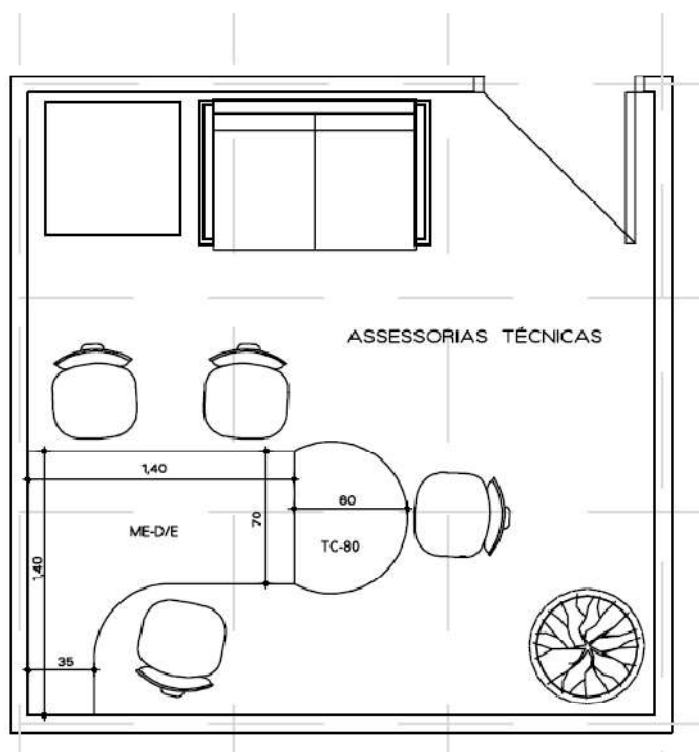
Planta baixa sala assessoria técnica. Área aproximada: 10m² (Fonte: Plano Diretor do CAFF)
